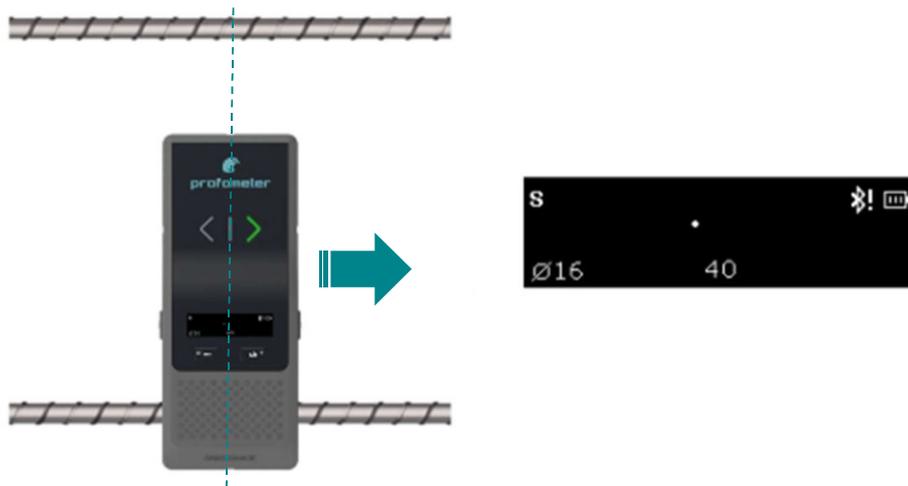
Parallel bewegen zu den Bewehrungsstäben
